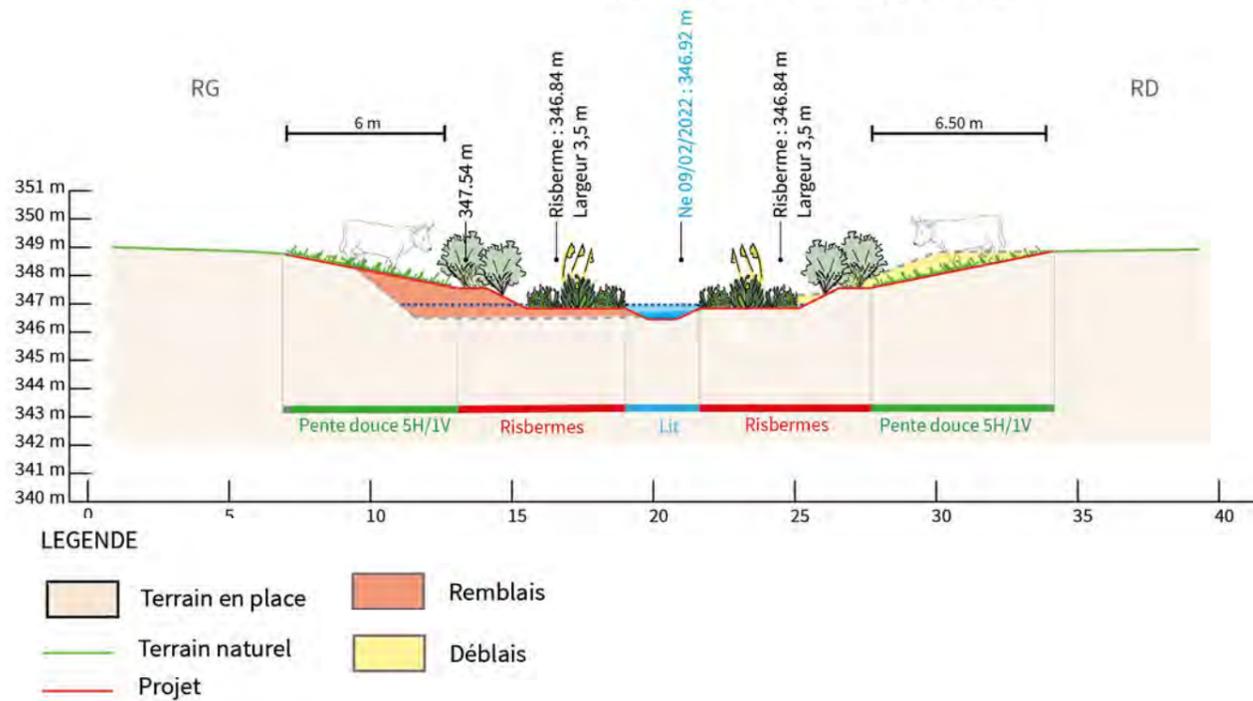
coupe de principe de la restauration du Suran au bois des Brus (coupe 1)
